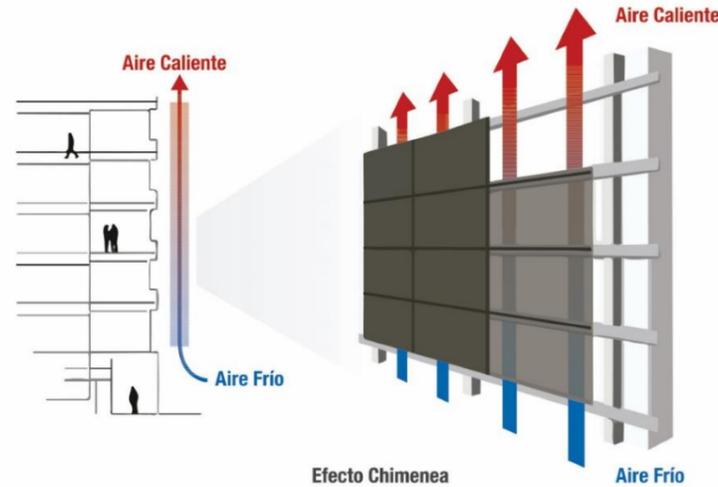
Fachada ventilada. Tomado de [www.a5fachadas.com](http://www.a5fachadas.com).
